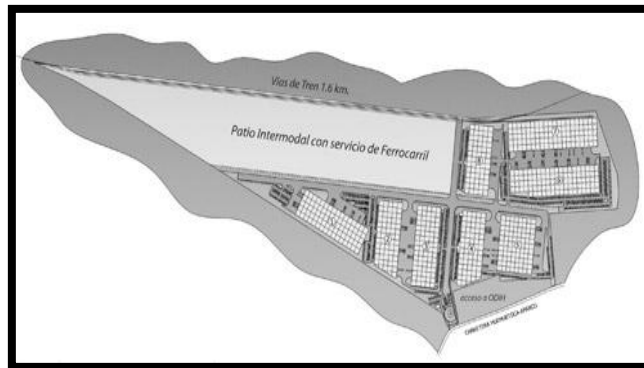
Plan maestro de O'Donnell en Huehuetoca.
